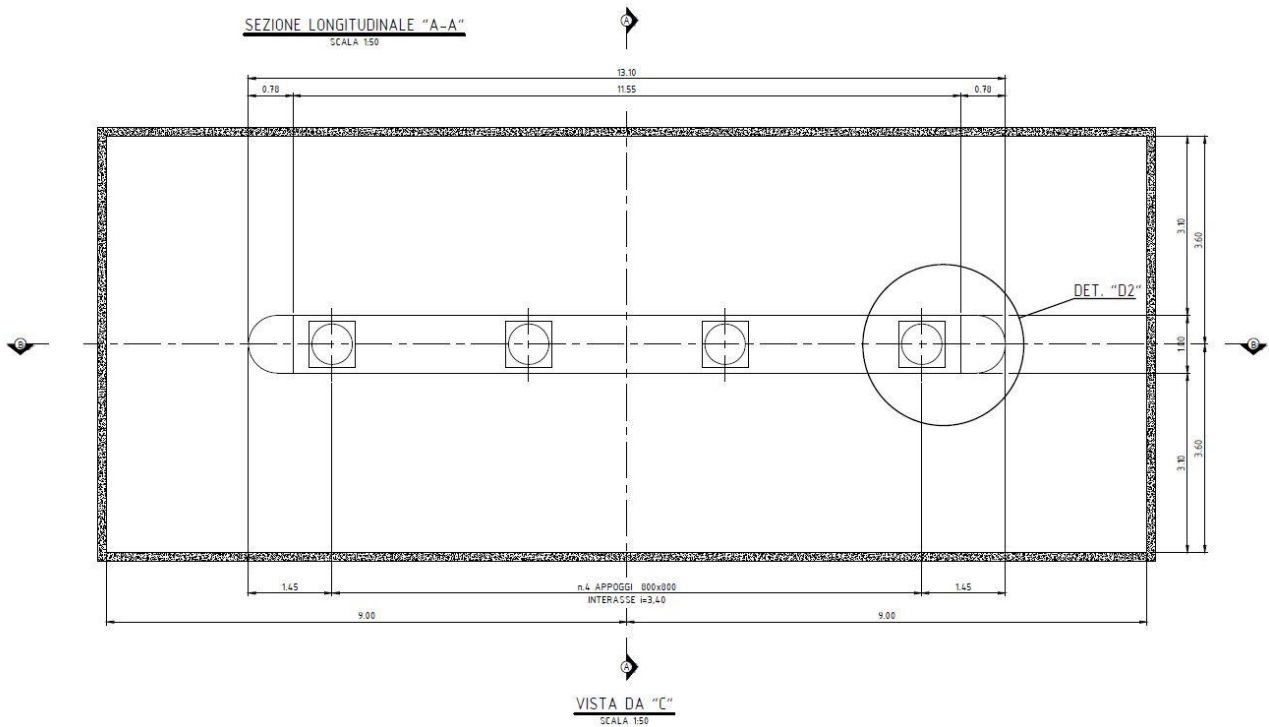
Vista in pianta della pila (piano degli appoggi)
